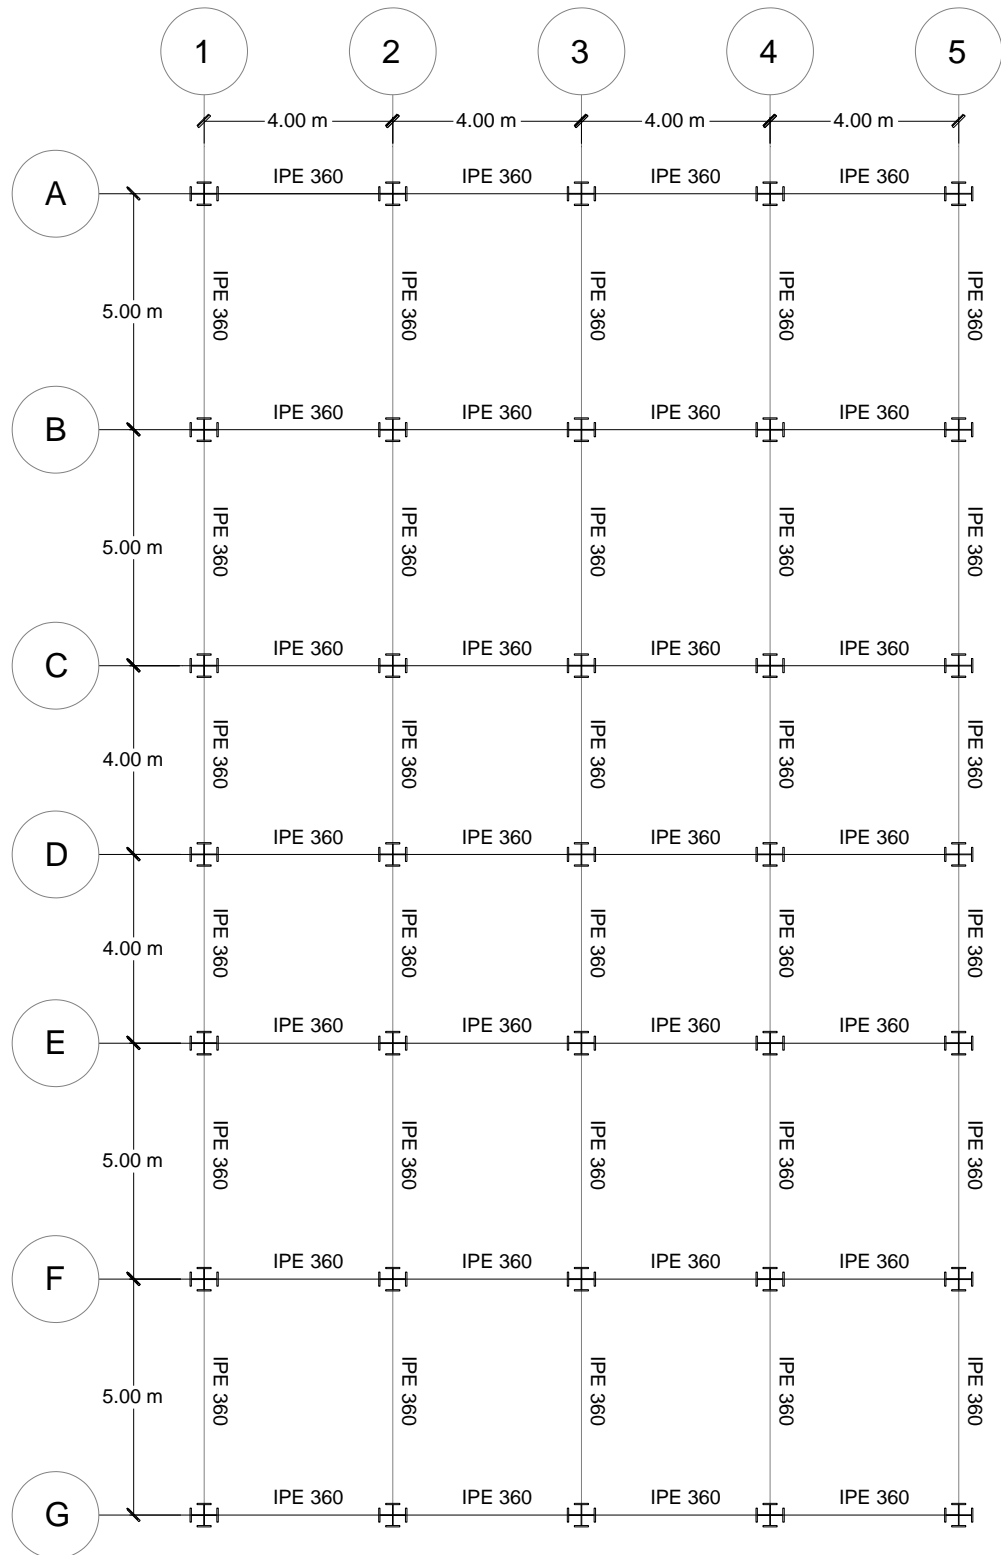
Secciones utilizadas vista en planta piso 1-3.
